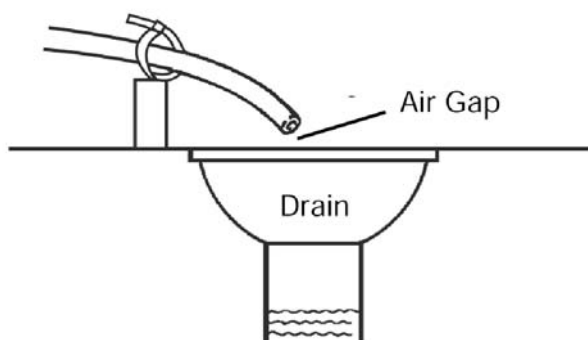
Przykładowy schemat montażu przedstawia schemat montażowy dołączony do instrukcji.
